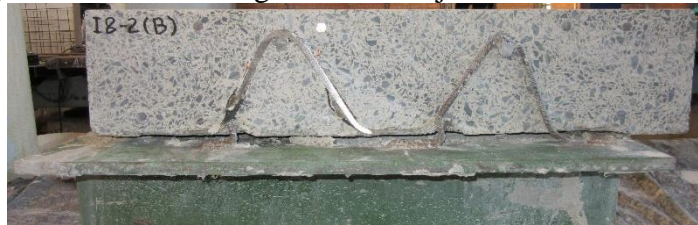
Corte longitudinal da laje B do modelo I8-2.
